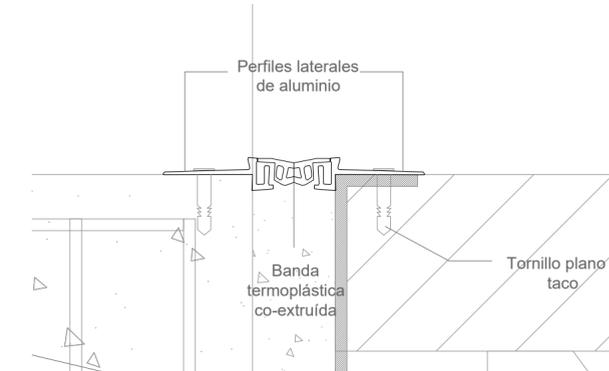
Detalle de la junta de dilatación. Fuente: Elaboración propia
